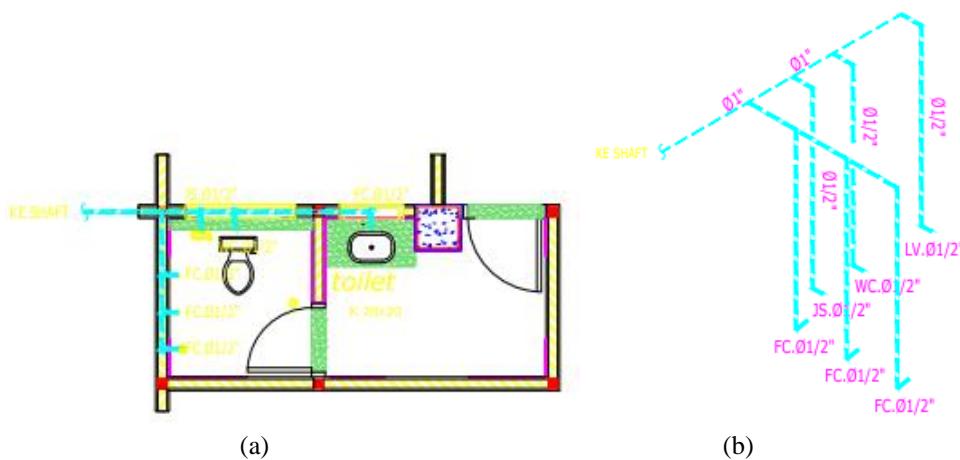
(a) Denah instalasi air bersih lantai 1, (b) Isometrik instalasi air bersih lantai 1
